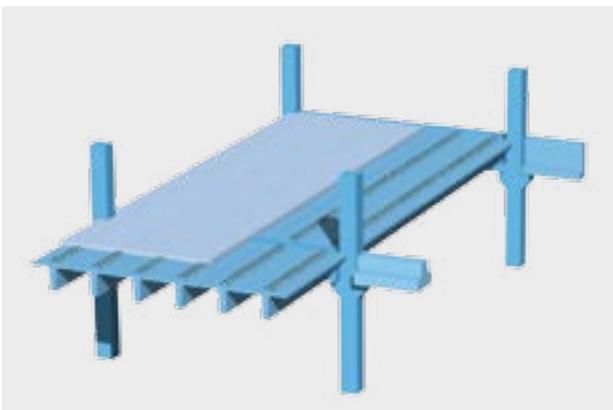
TT-Platten mit Ortbetonerfüllung
